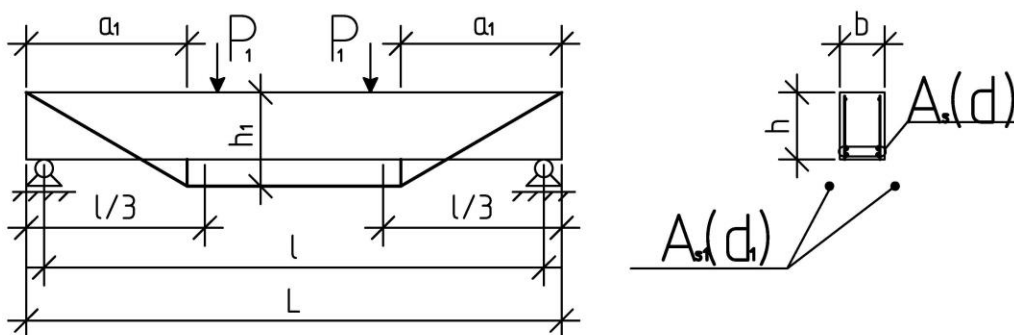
Расчетная схема исследуемой железобетонной балки, усиленной шпренгелем
